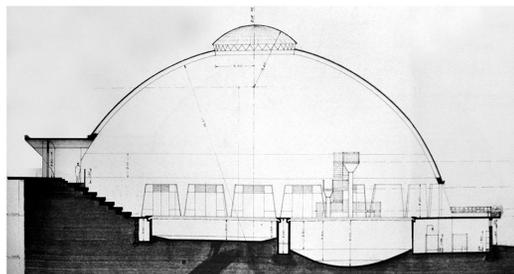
Piscina cubierta UNL, no construida. Loja, 1980
